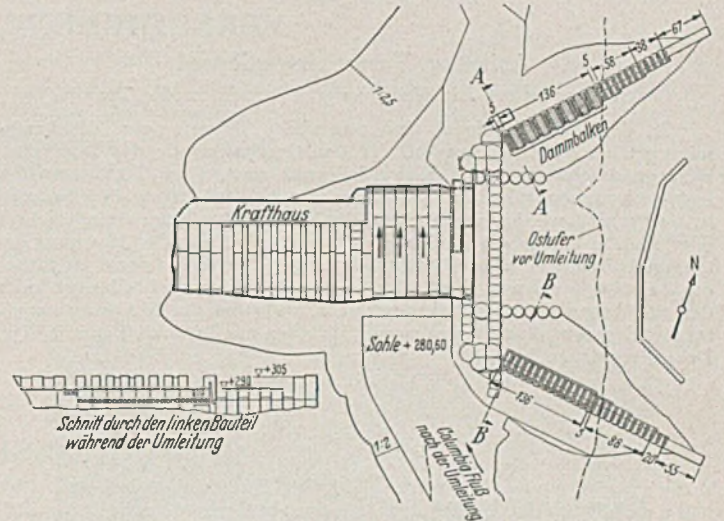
Grand Coulee-Damm. Lageplan mit Fangedamm für den 2. Bauabschnitt. Schnitt durch den linken Bauteil.
